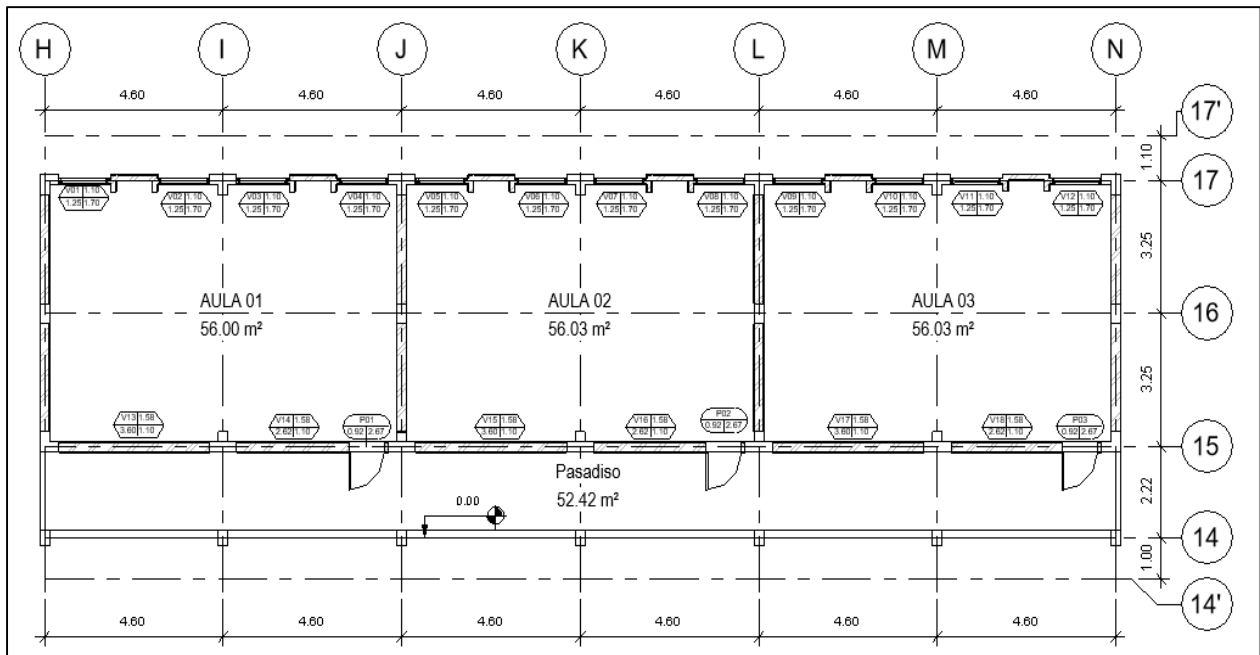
Planta baja del bloque 01 de la I.E. N°50217
